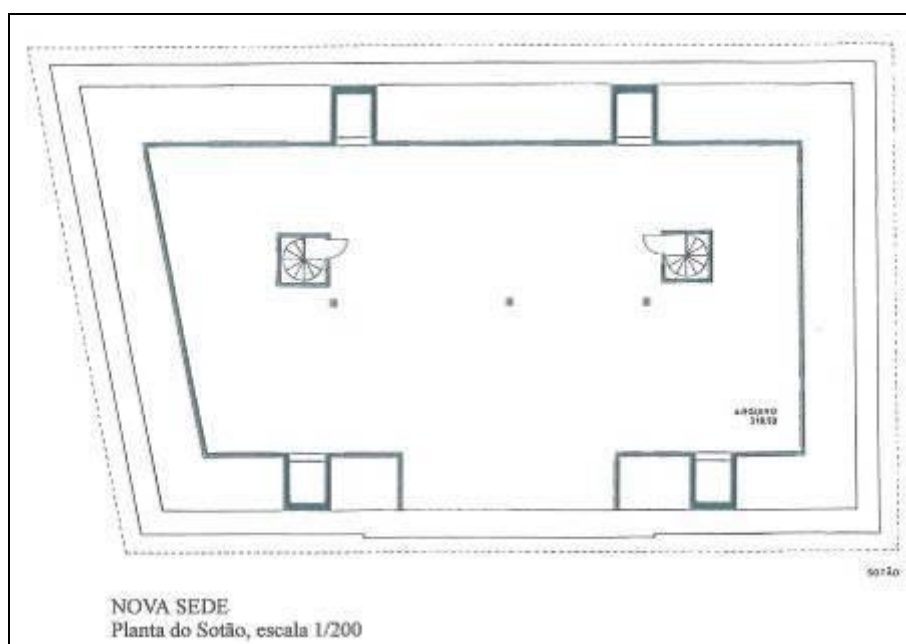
Planta do sótão da casa dos Pereira Coutinho / casa dos Vilhenas (sede da Santa Casa de Misericórdia). Escala1/200<sup>542</sup>.
